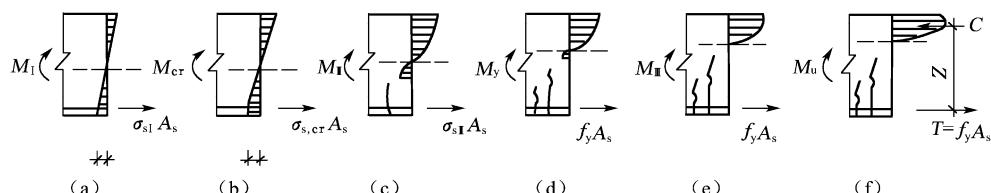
钢筋混凝土纯弯曲梁正截面应力发展过程
